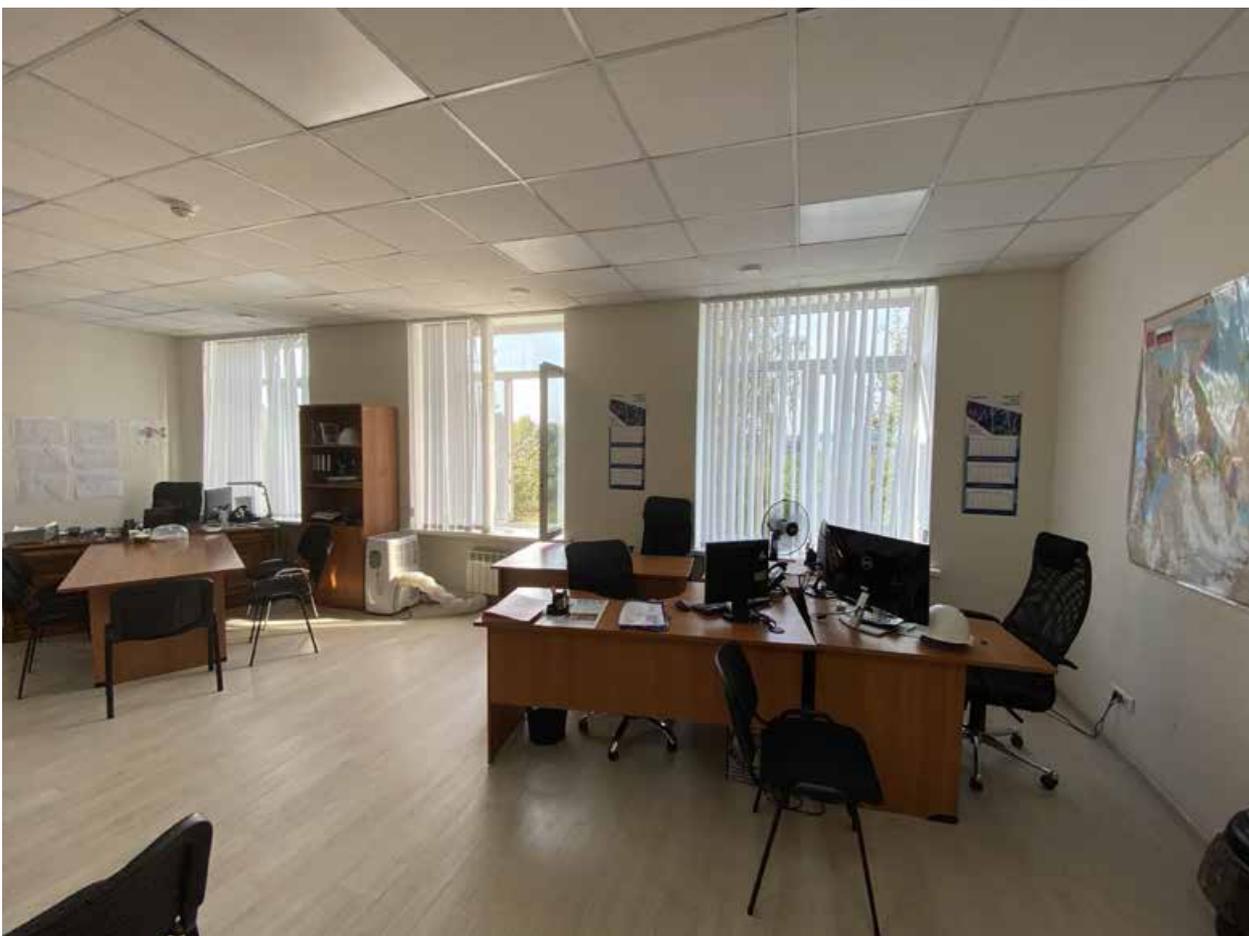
3 этаж. Помещение 6-Н(42-44).
